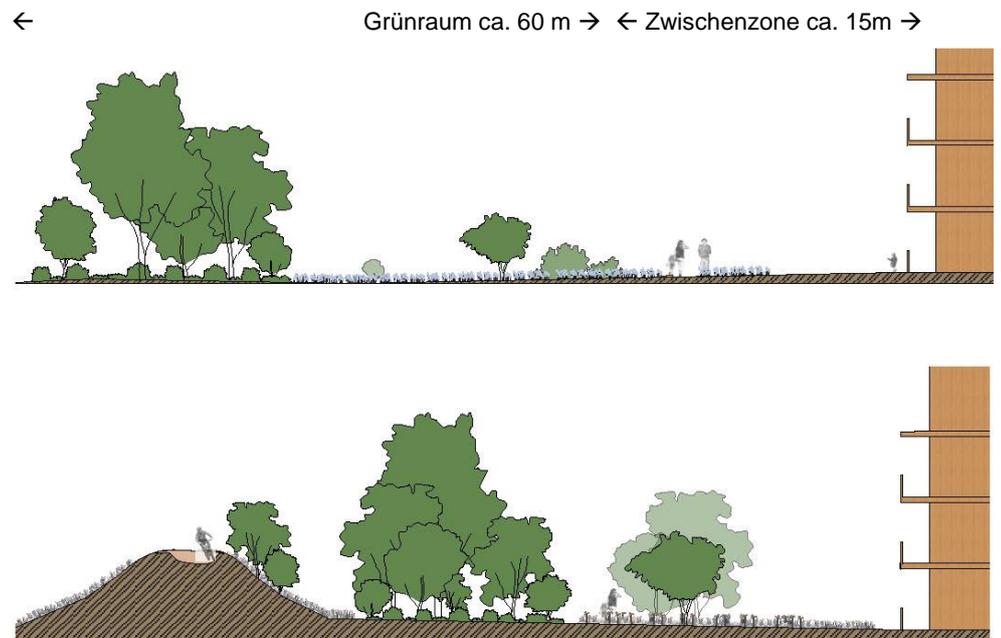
Schnitte durch den öffentlichen Grünraum (ohne Massstab)
